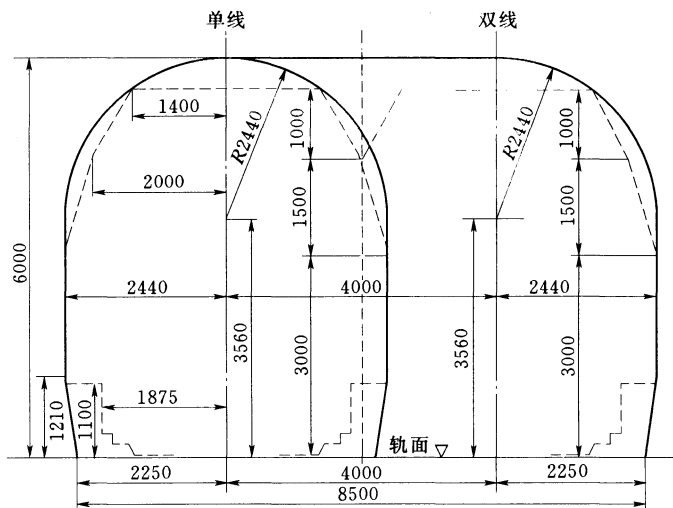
隧道建筑限界 (隧限-1A、隧限-1C) (单位: mm)
